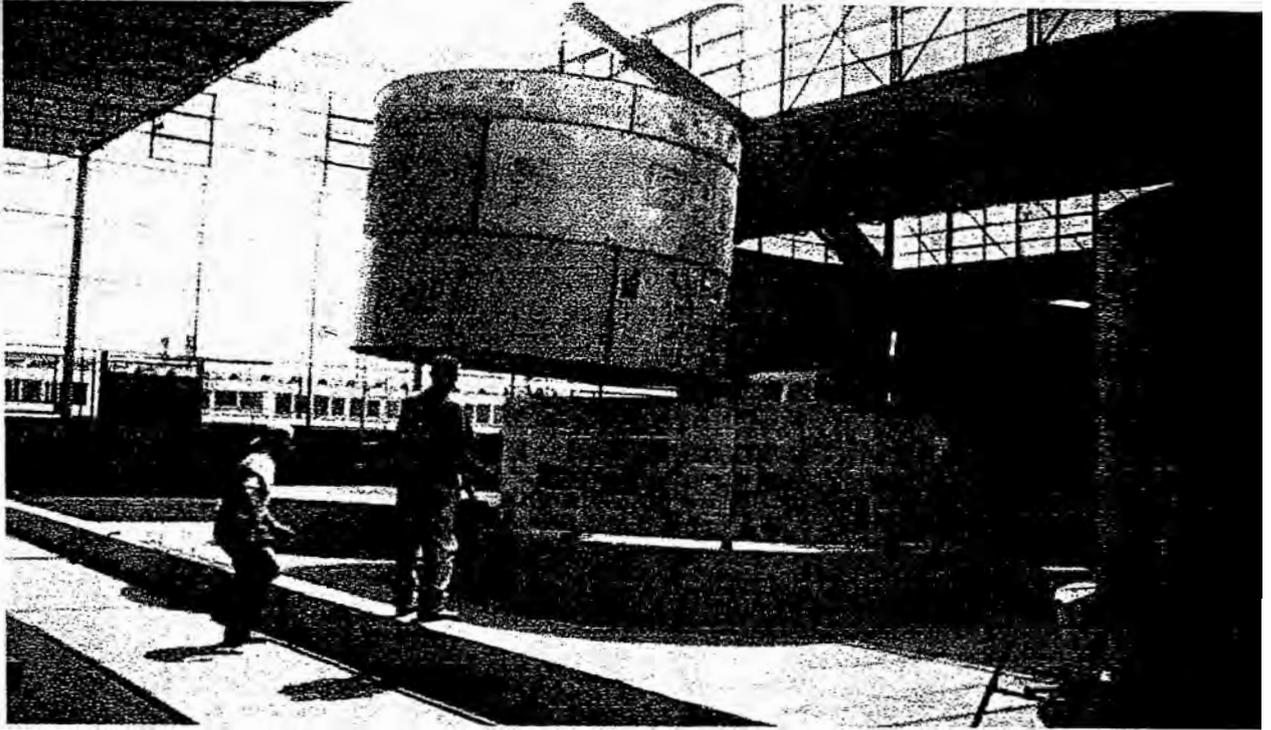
(parte superior) Vista de montaje de anillos del tanque de 80 m³.
